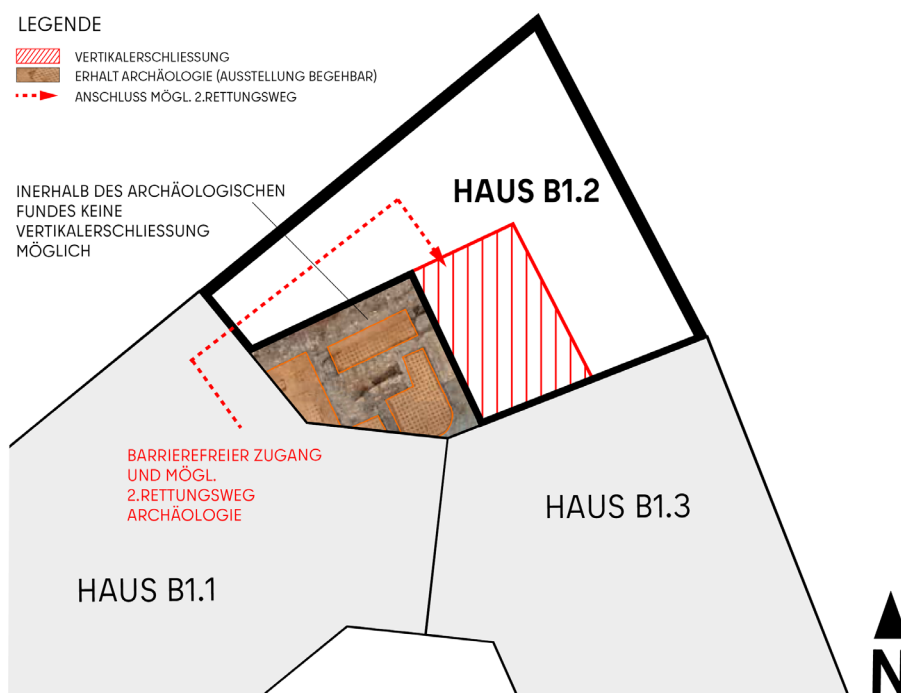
Schematischer Grundriss Untergeschoss
